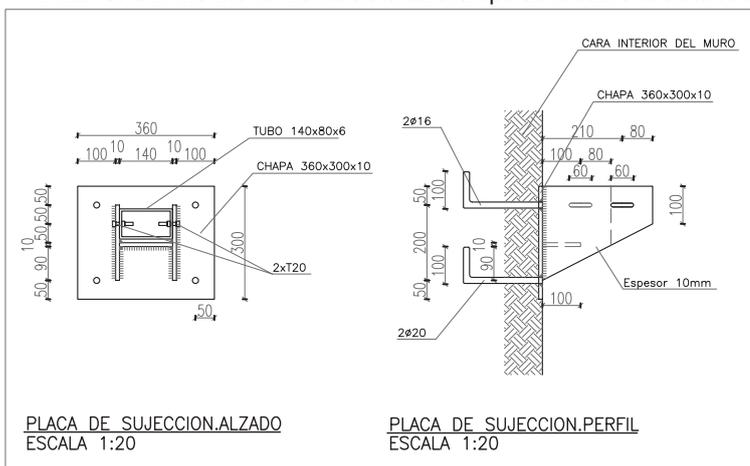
Detalle del apoyo de la cercha. Escala 1:40 [27]
